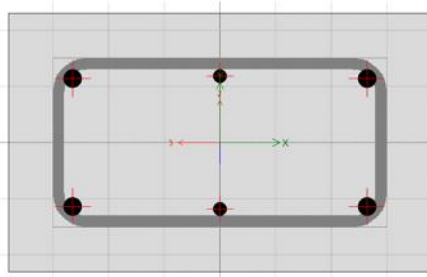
Distribución de varillas de acero vertical en la columna C1.
